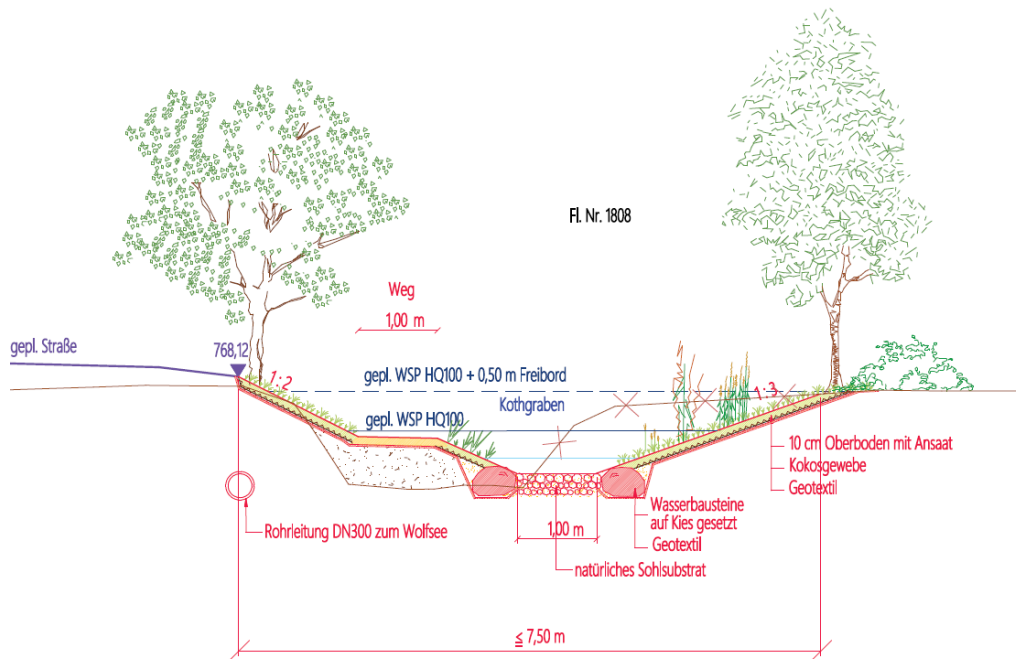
Planauszug – Planungsabschnitt Gewässerausbau Kothgraben, RQ 1
